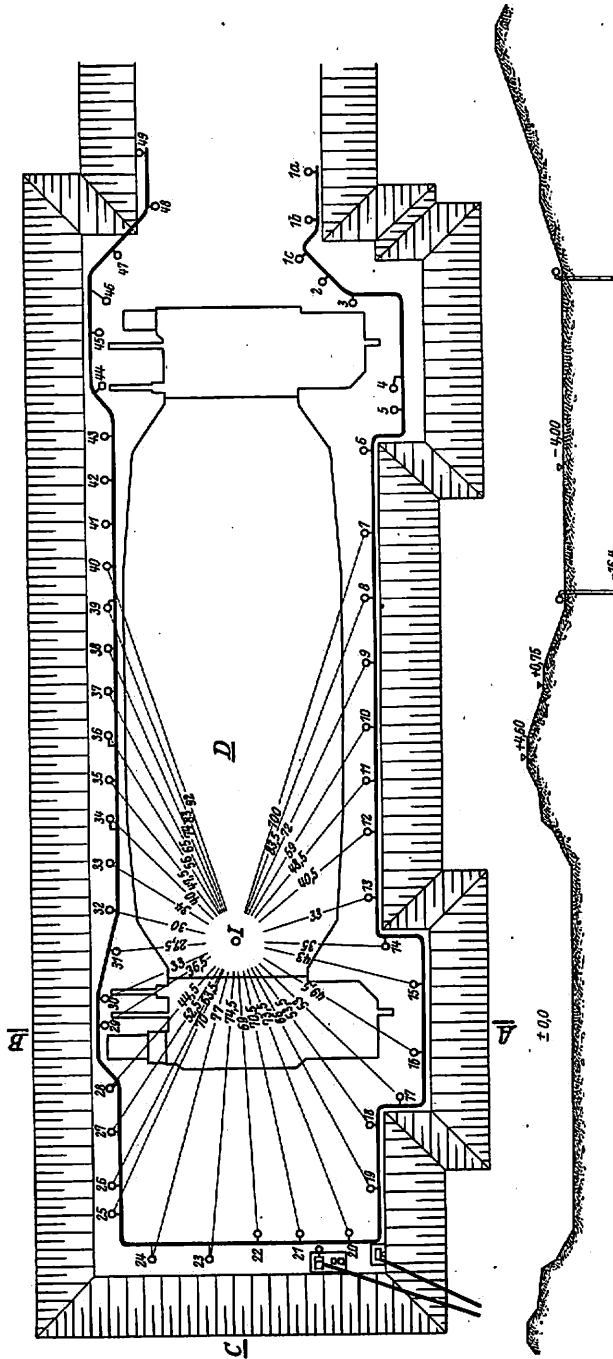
Senkungsanlage für Schleuse Wemeldinge; Grundriß und Längsschnitt.
